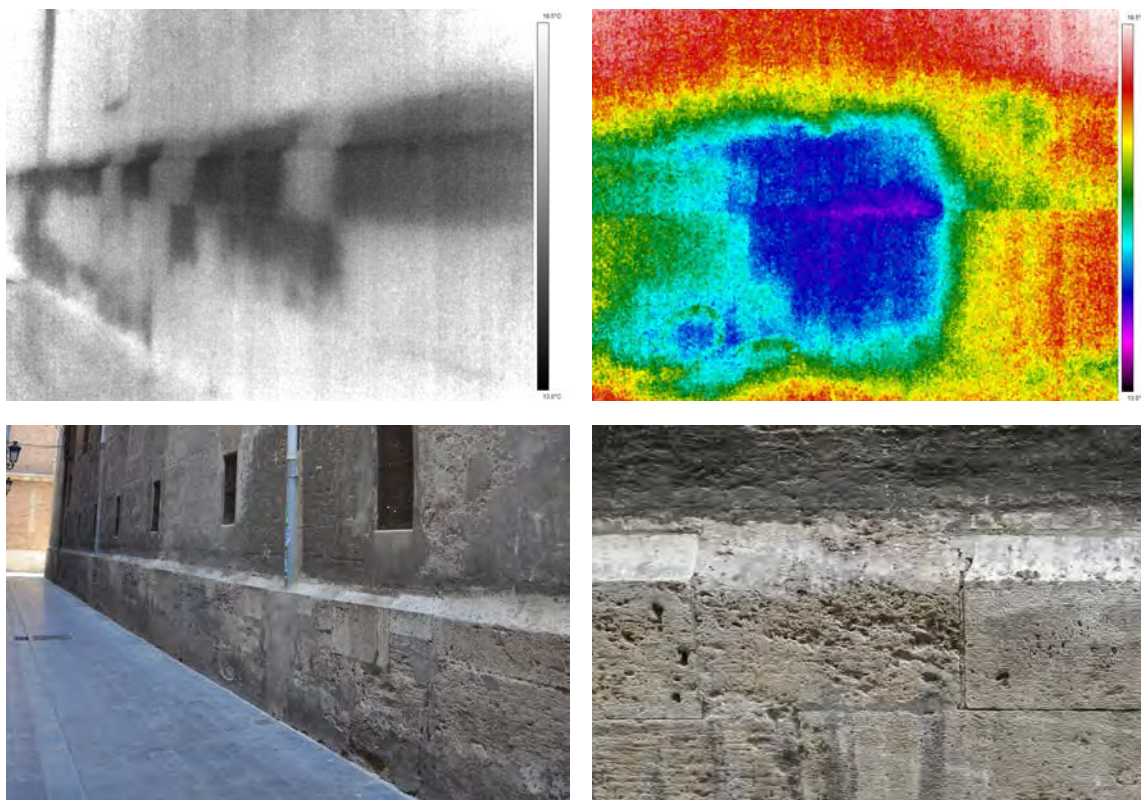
Vista general y detalle del zócalo de la fachada este.
